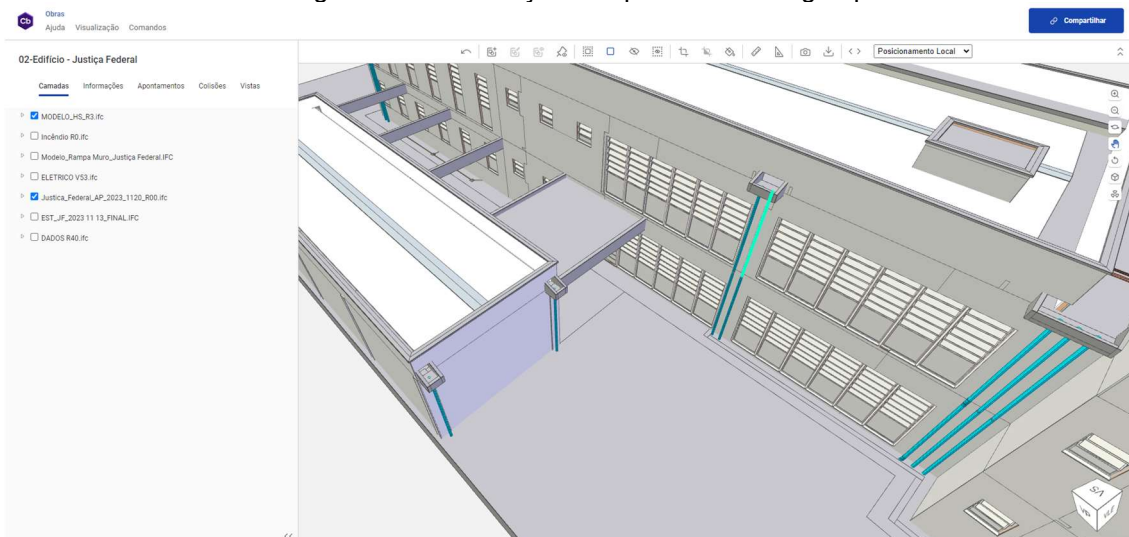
Verificação dos pilares do 1 pavimento que nascem na viga de transição
